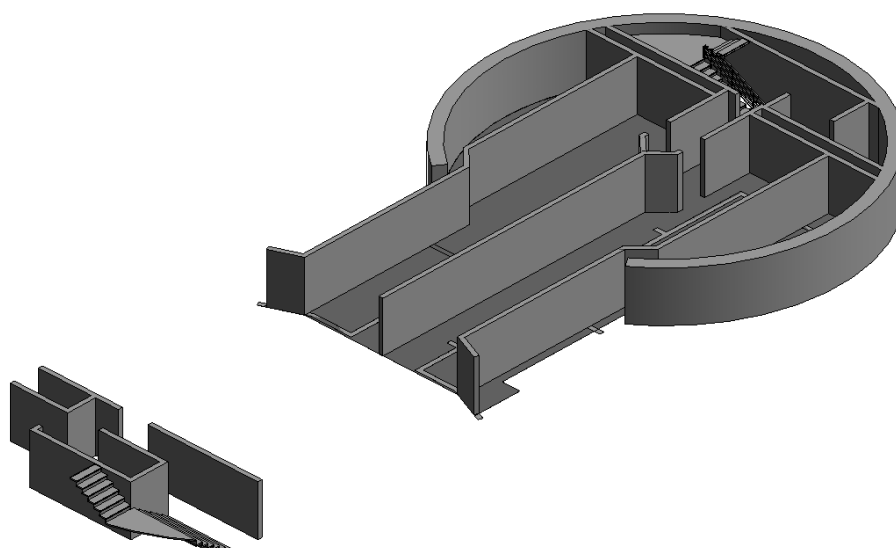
2º Pavimento: Chegada dos dutos de ventilação
